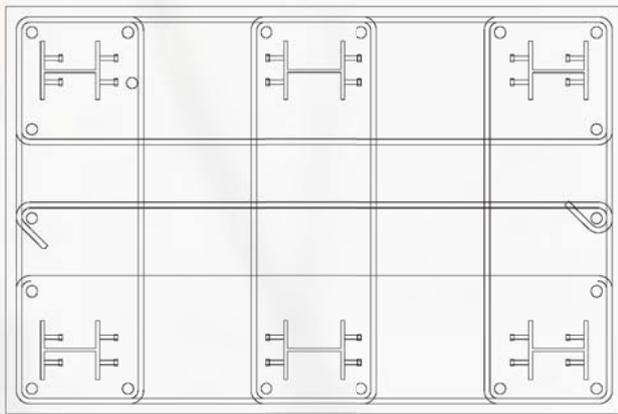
鋼與混凝土複合式橋柱剪力釘之斷面配置
